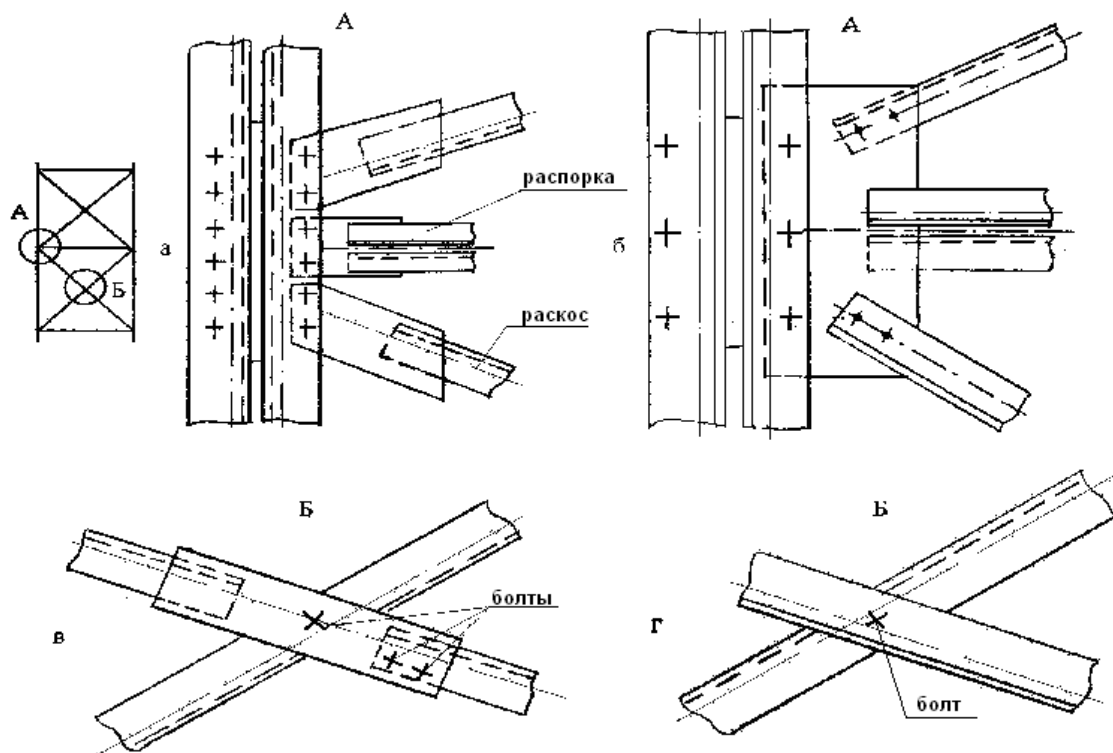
Примеры узлов крепления горизонтальных связей к поясам ферм
